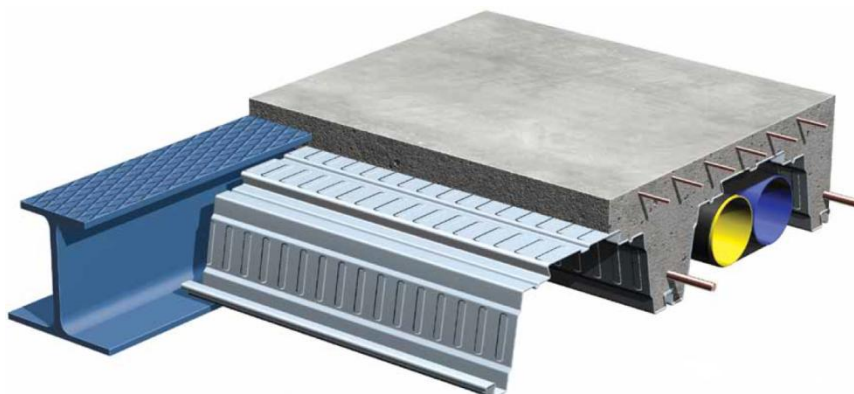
Pormenor do pavimento "*slim floor*" (TS@, 2010).
